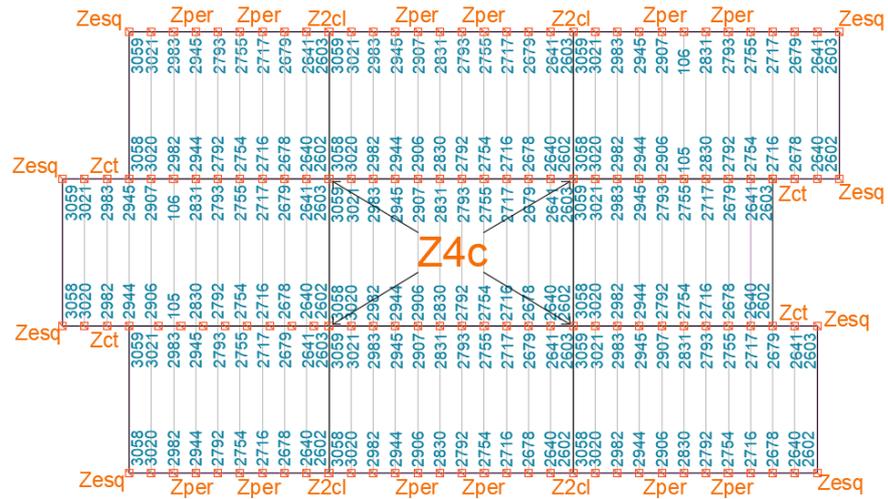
Implantación con la distribución de zapatas aisladas.
